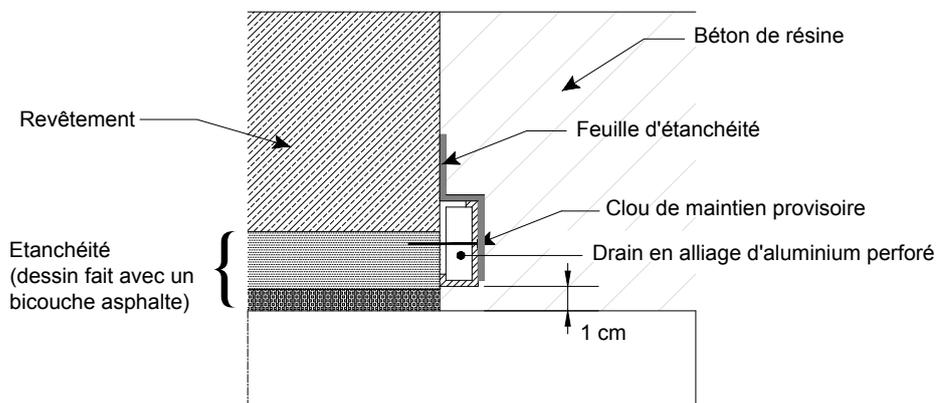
Position et maintien du drain dans le cas d'une étanchéité bicouche asphalte 8 + 22
